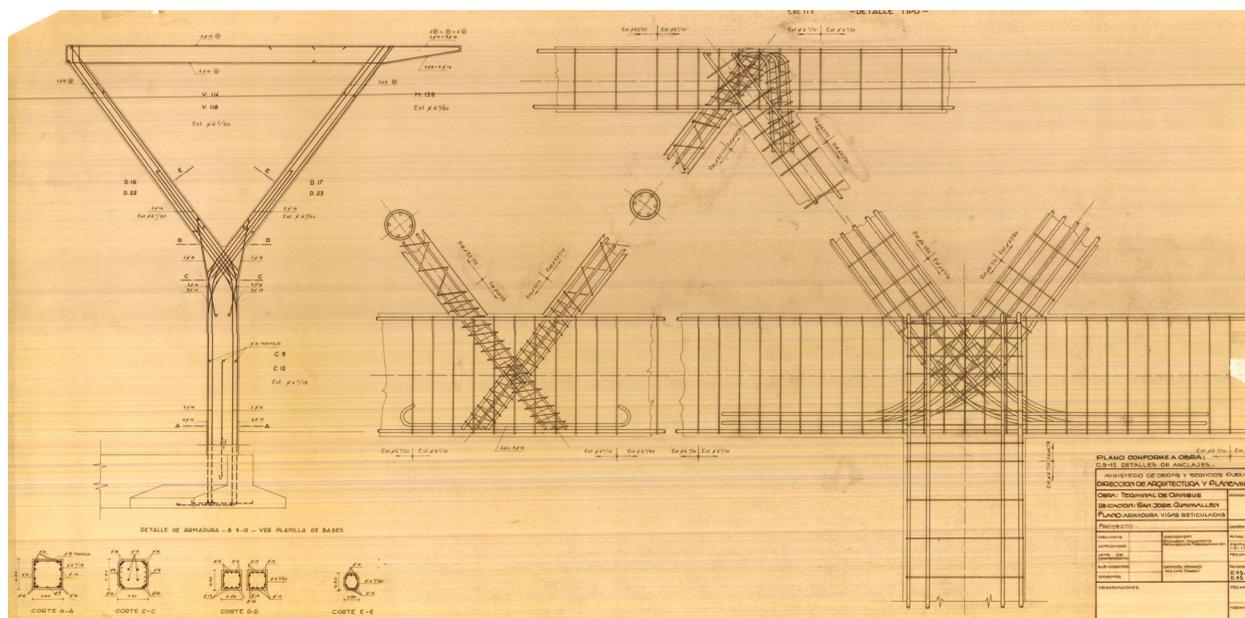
Detalle de las armaduras de vigas reticuladas. Fuente: Archivo Digital de la DAI-MIPIP, Gobierno de Mendoza.
